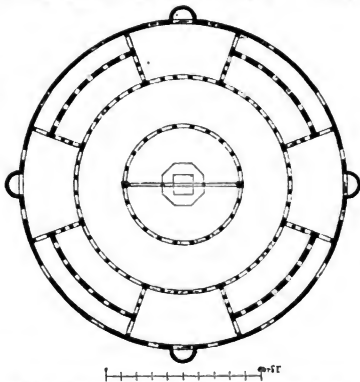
Grundriss von S. Stefano rotondo in Rom (nach Rahn).
